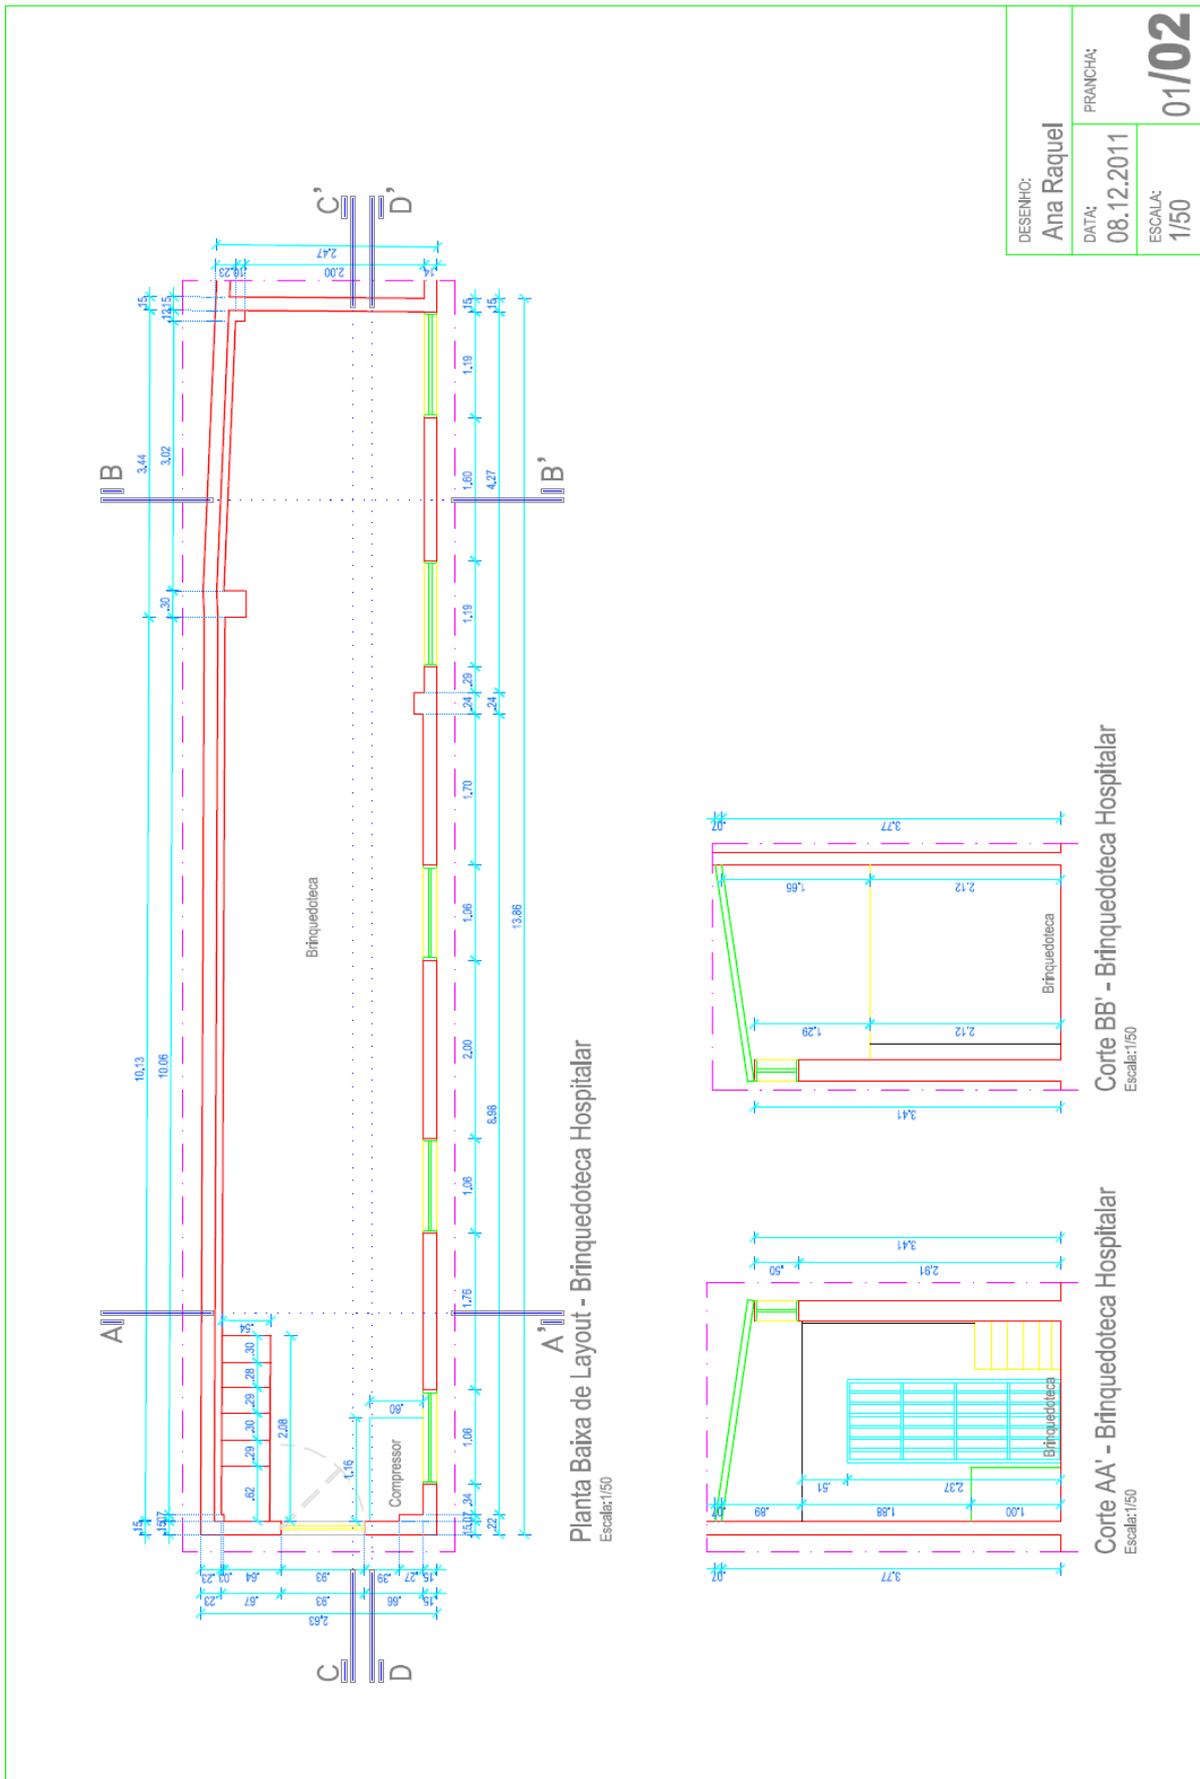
Levantamento físico da brinquedoteca e cortes AA' e BB'
